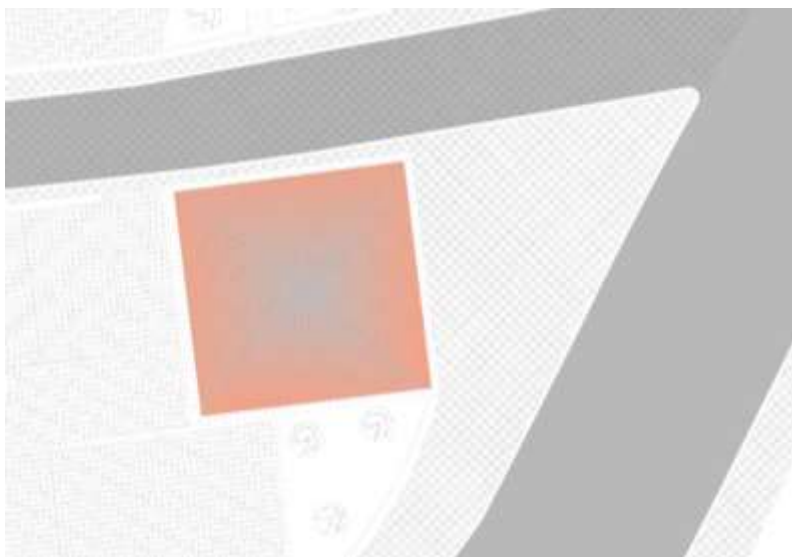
Planta de implantação da proposta de modificação da Rua da Fonte, edifício de fecho.
